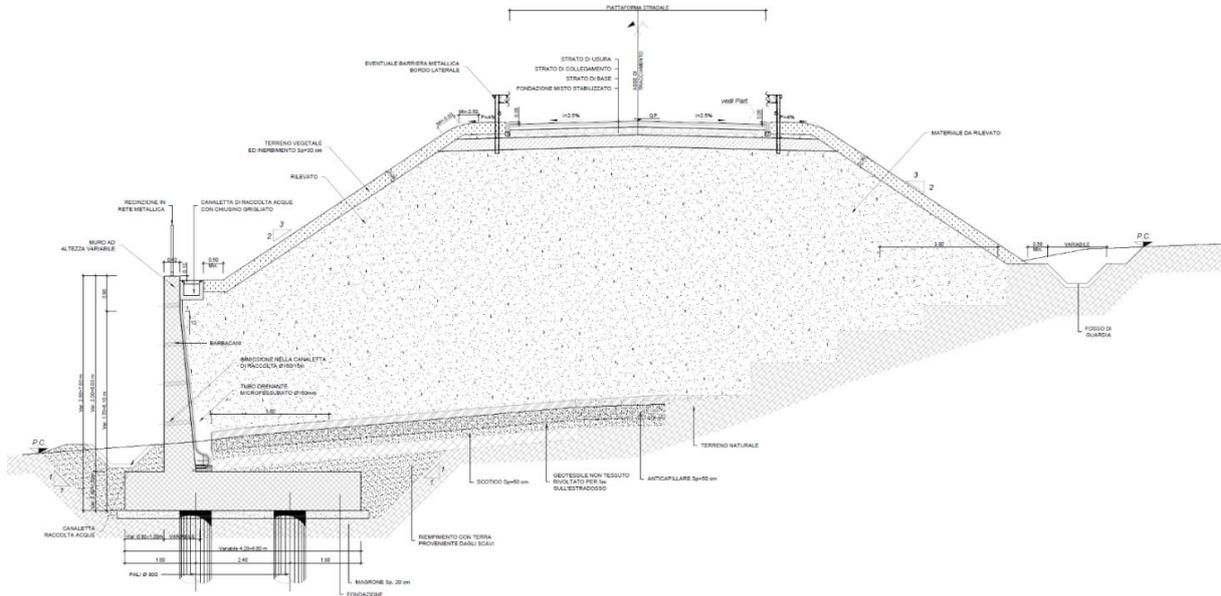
Sezione tipo in rilevato con muri di sottoscarpa (tipo S-1)
